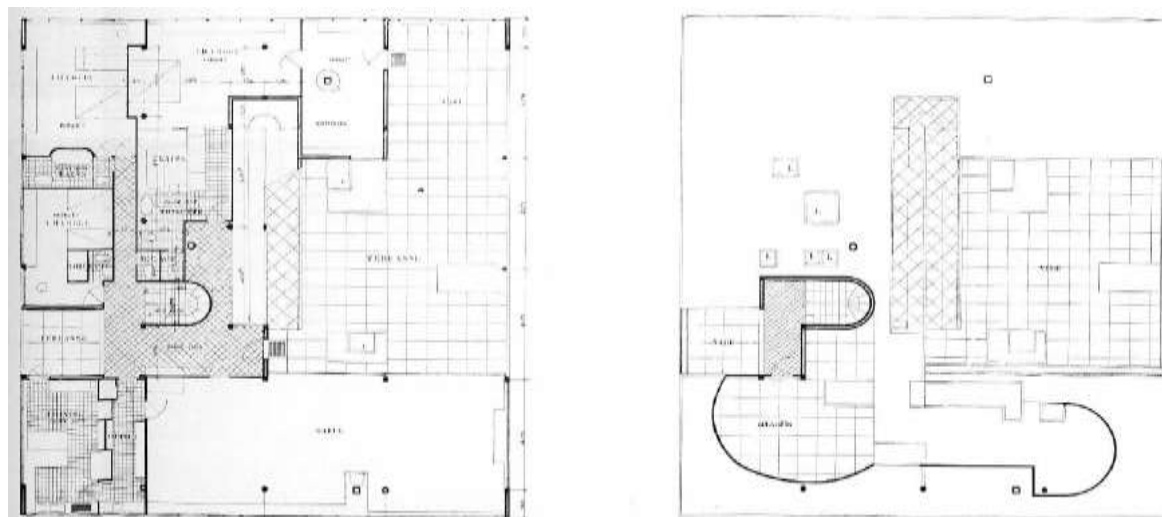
Planta do primeiro pavimento e do terraço-jardim da Villa Savoye, em Poissy
